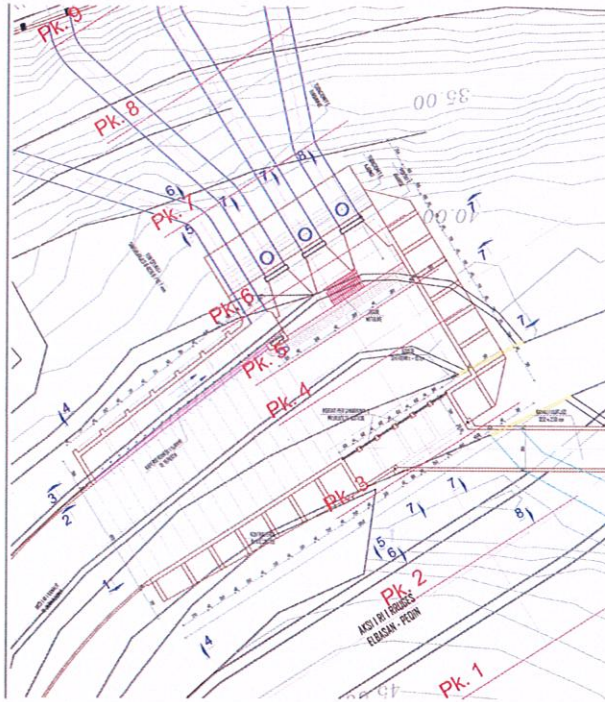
Planimetria e basenit te presionit te HEC –it Peqin
